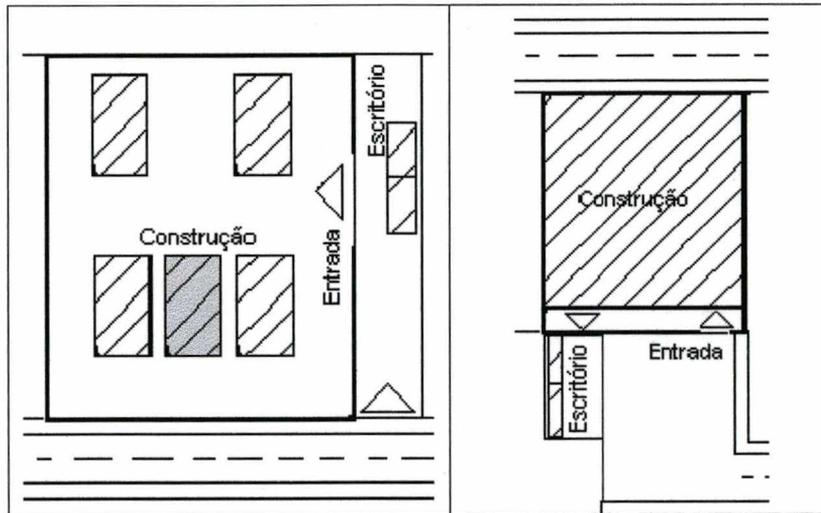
Layout* do canteiro de obra das lajes maciça 1 e 2 respectivamente.
